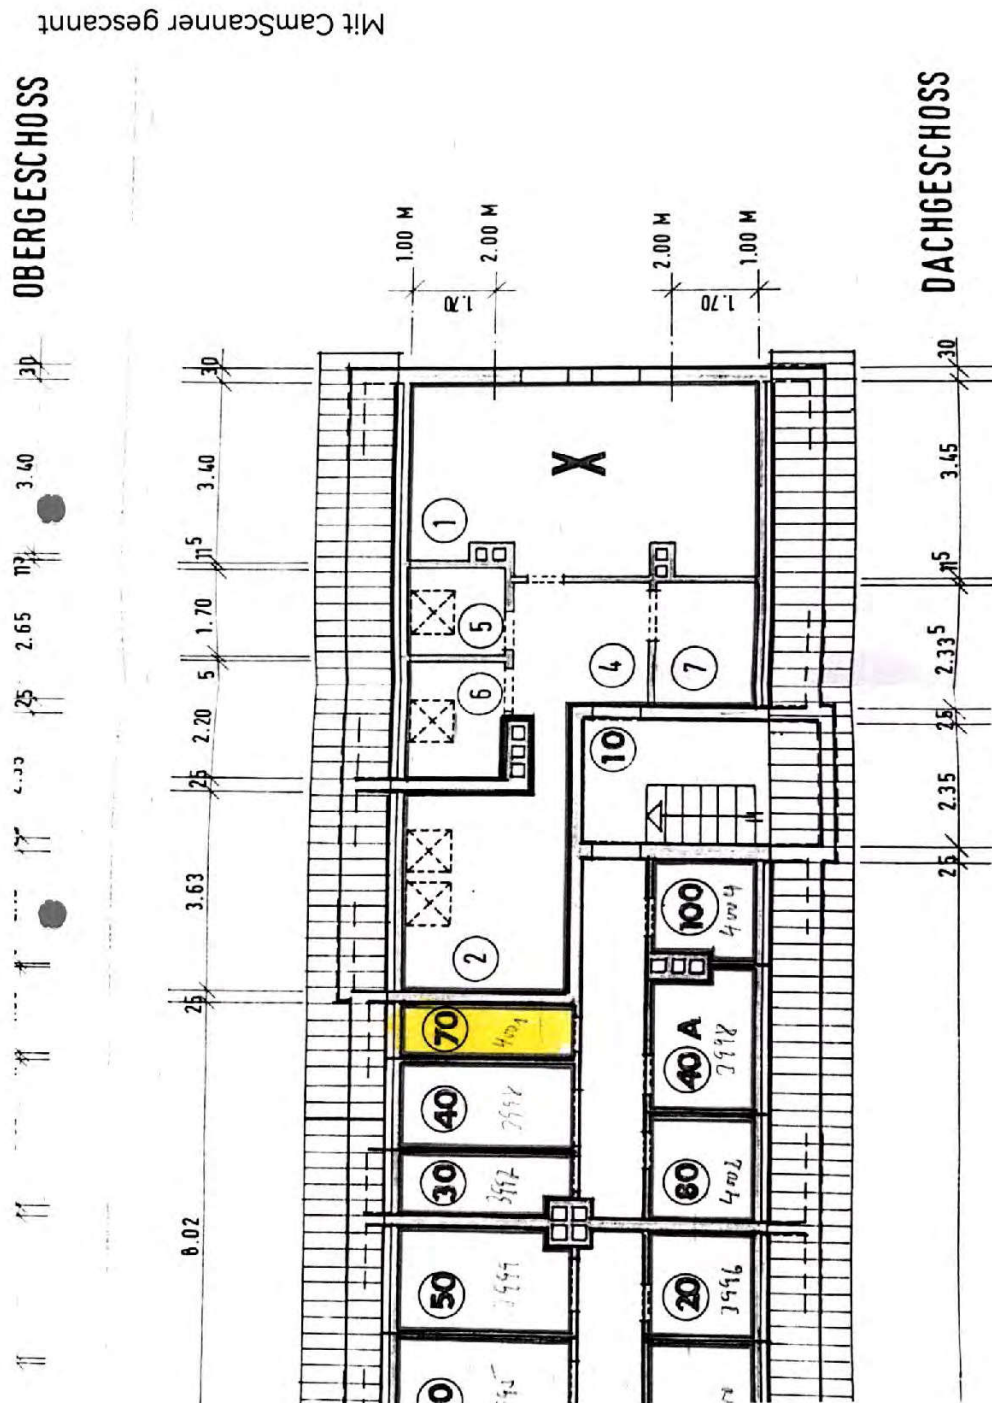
Teilgrundriss DG mit Kennzeichnung zugehöriger Bodenraum
